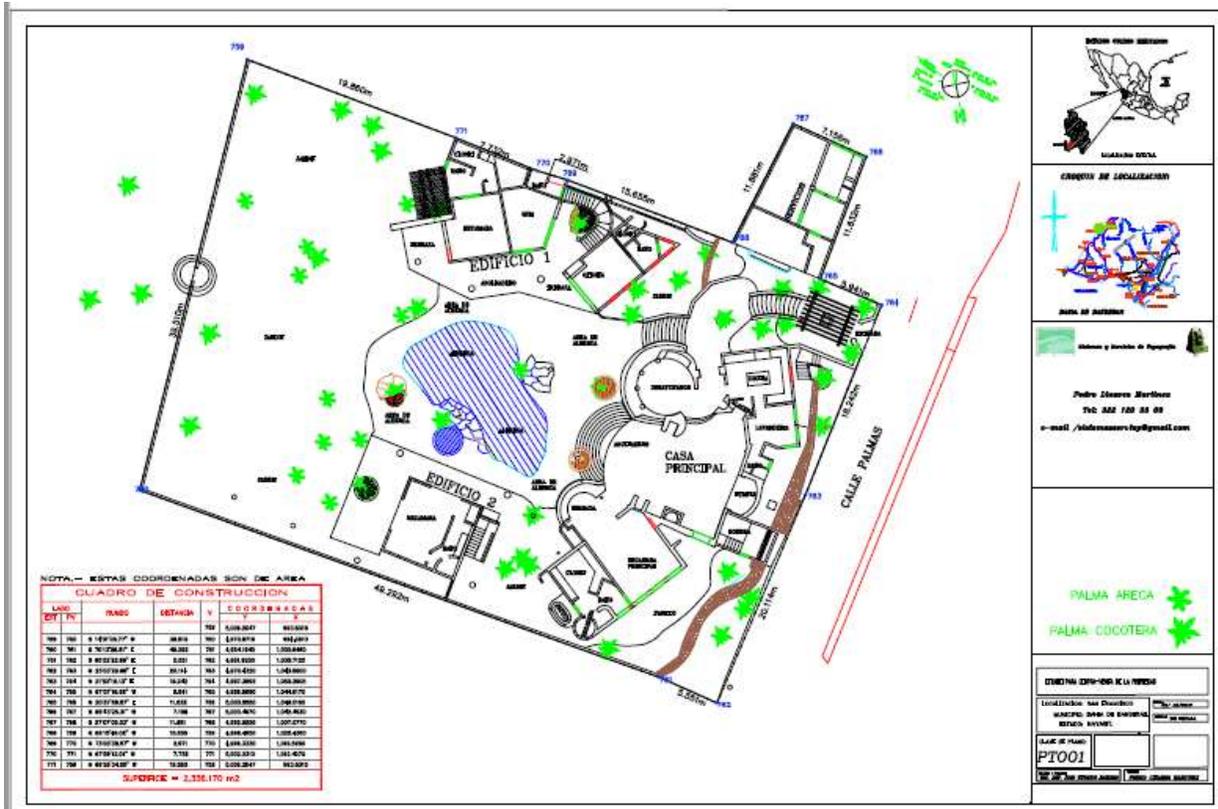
Planta de conjunto del proyecto “Casa Cielito”
